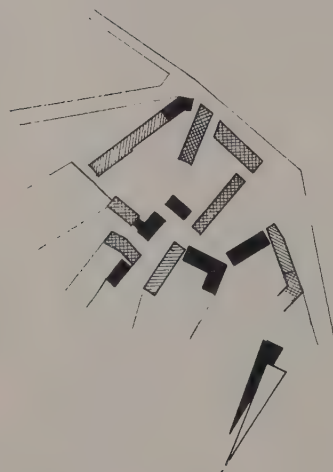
Ausschnitt aus dem Bestandsplan Poley
